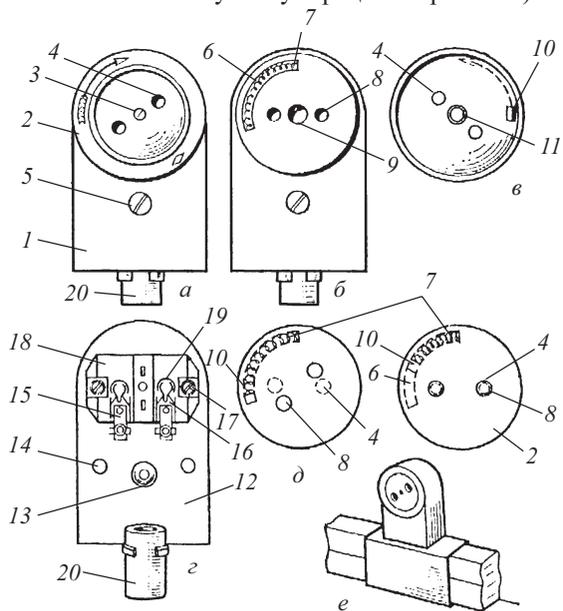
Штепсельная розетка с защитным устройством для открытой установки над плинтусом
